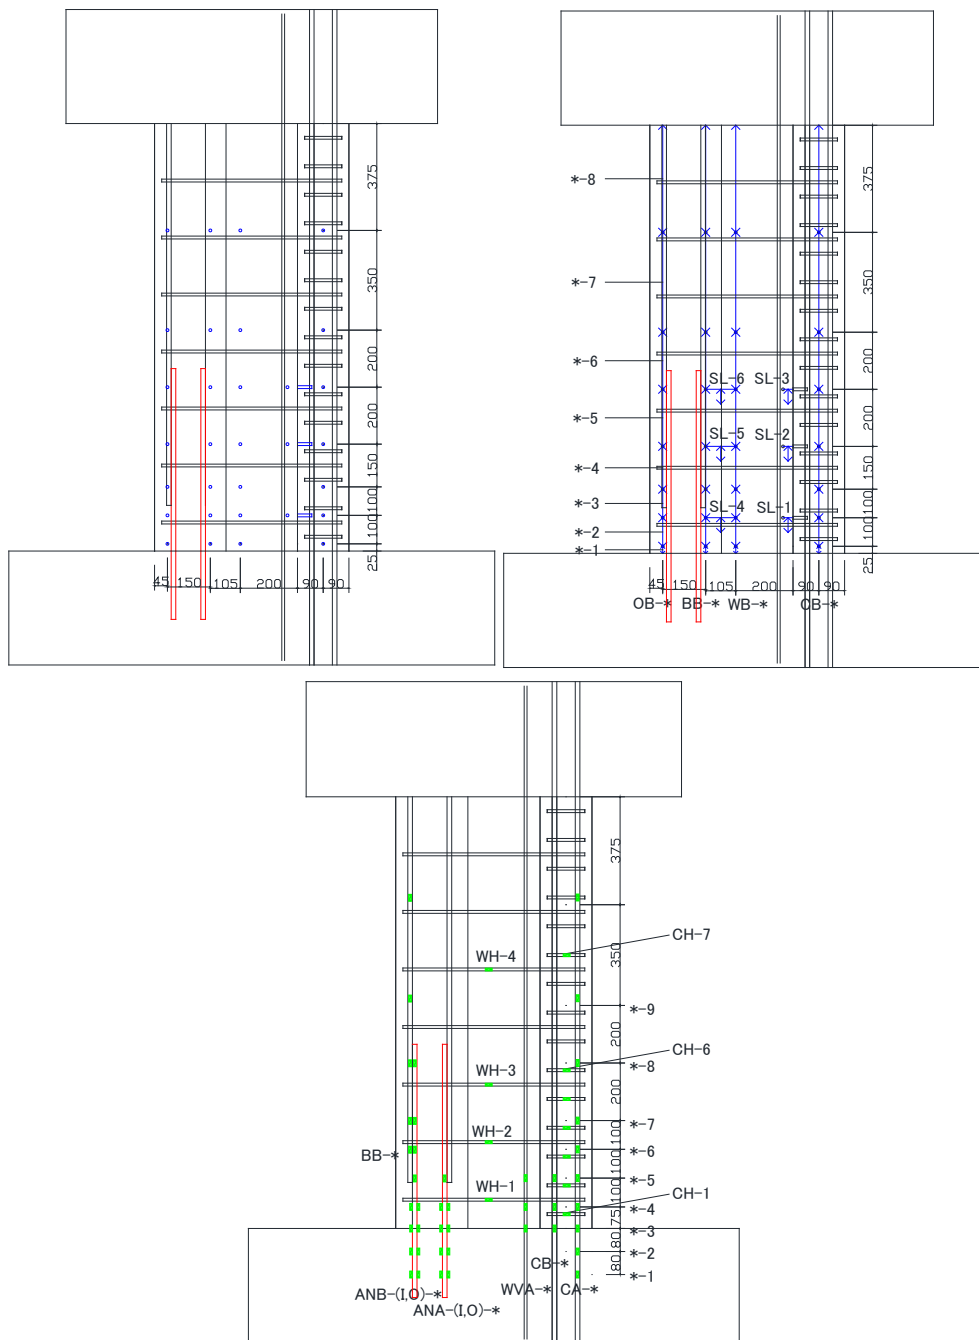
試験体 No.2 インサート，変位計，ひずみゲージ位置説明図
